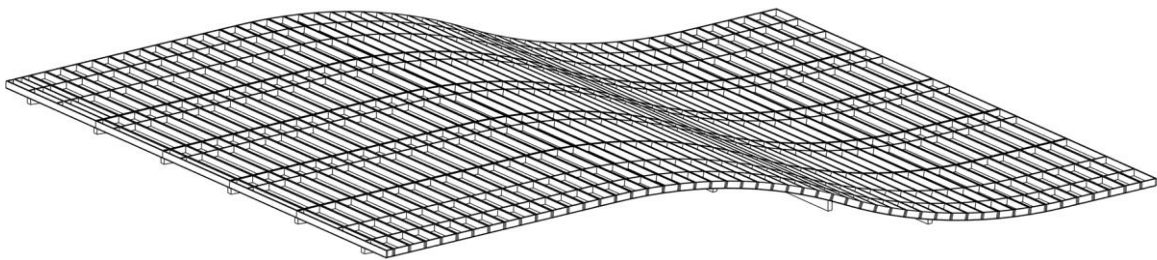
Ossature et voliges douglas support isolation et contreventement – document de fabrication des Charpentiers du Haut Beaujolais
